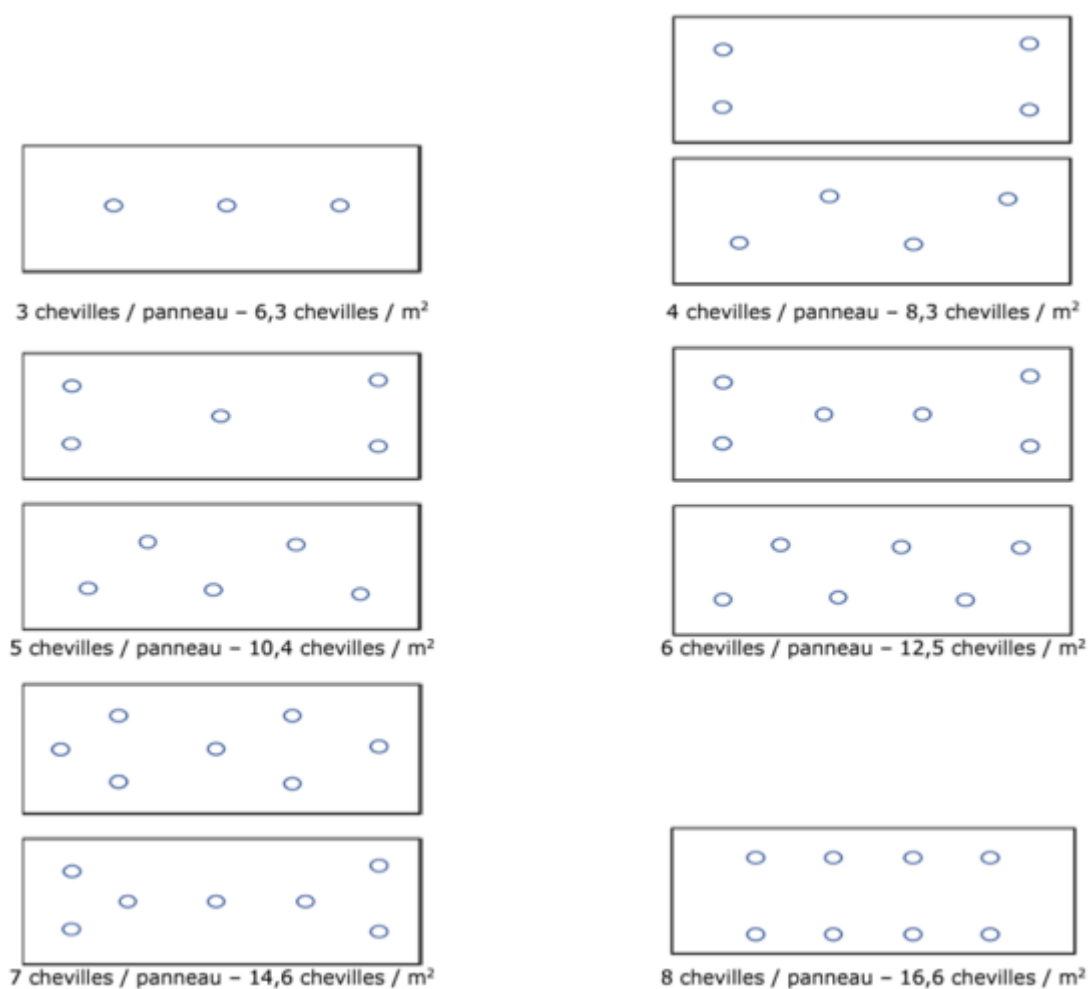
Plans de chevillage - panneaux de dimensions 1200 x 400 mm – Chevillage en plein - (espacement entre chevilles ≥ 100 mm et distance au bord ≥ 100 mm)
